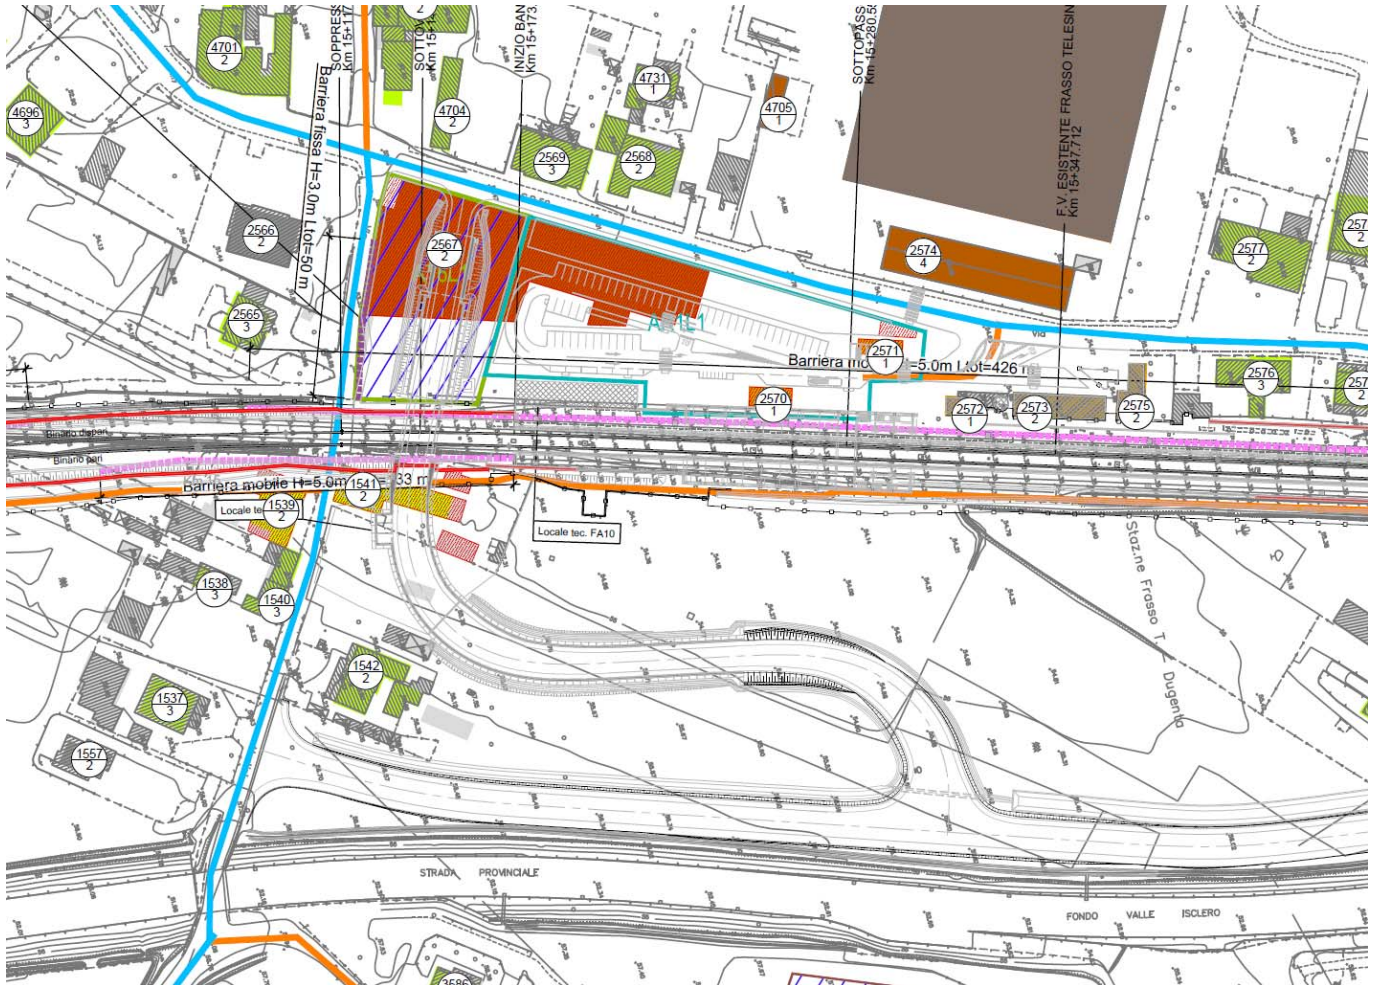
Estratto elaborato IF1N.01.E.ZZ.P6.CA00.0.0.022 - Planimetria localizzazione interventi di mitigazione (11/11)
